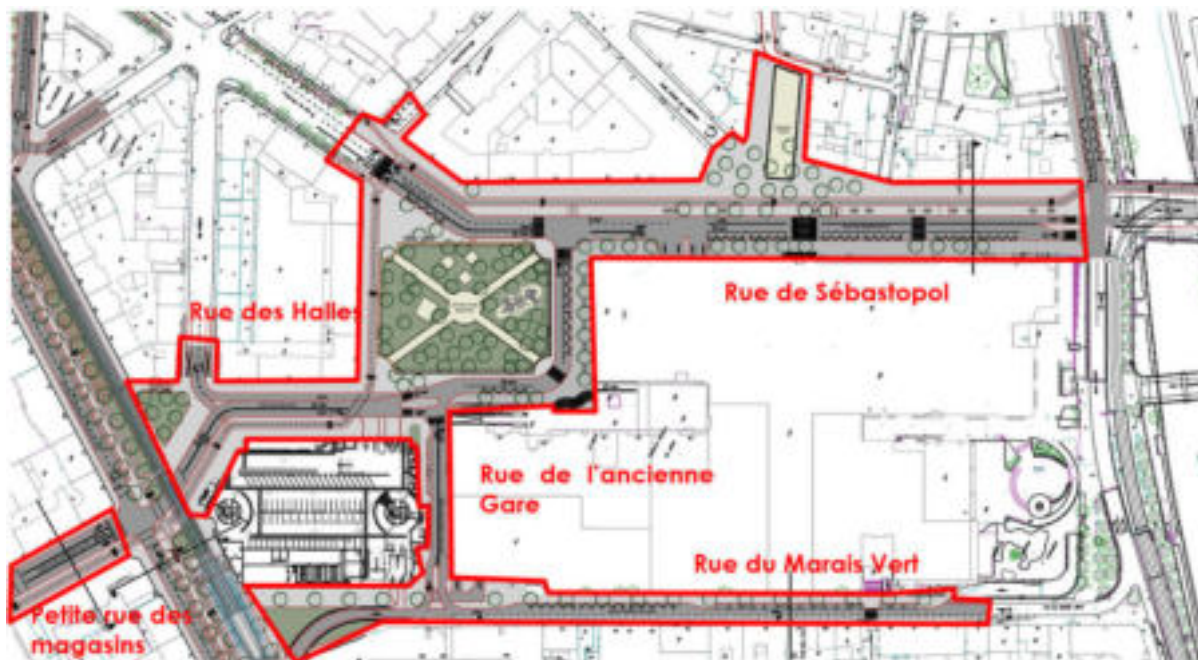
EMPRISE DU PROJET – SECTEUR HALLES
